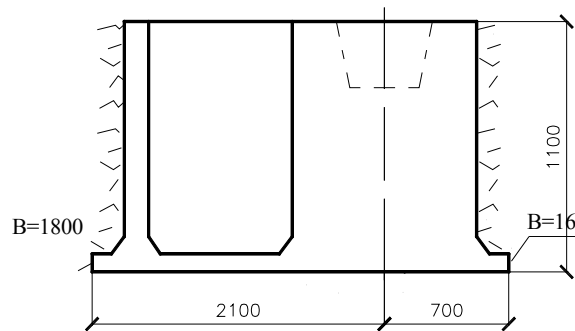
Блочний фундамент з додатковою вертикальною стінкою (Пензенський ІБІ)
